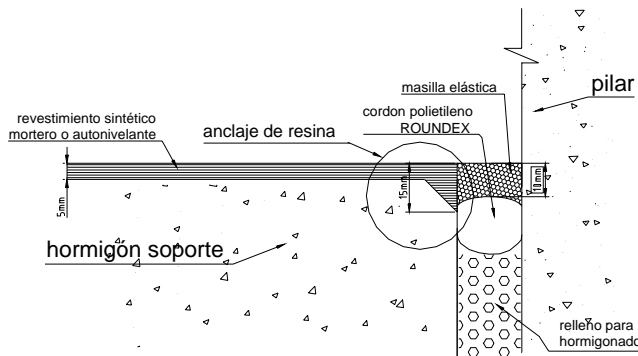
Detalle de una junta de dilatación con refuerzo metálico.
